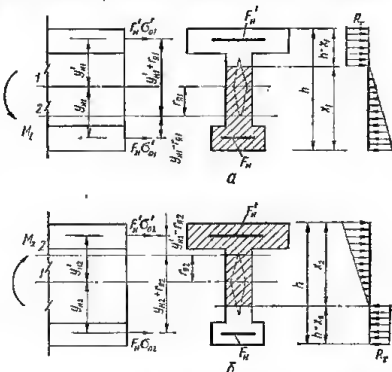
Схемы внутренних усилий в сечении предварительно напряженного элемента при подборе площади сечения напрягаемой арматуры из расчета по образованию трещин зоны:
